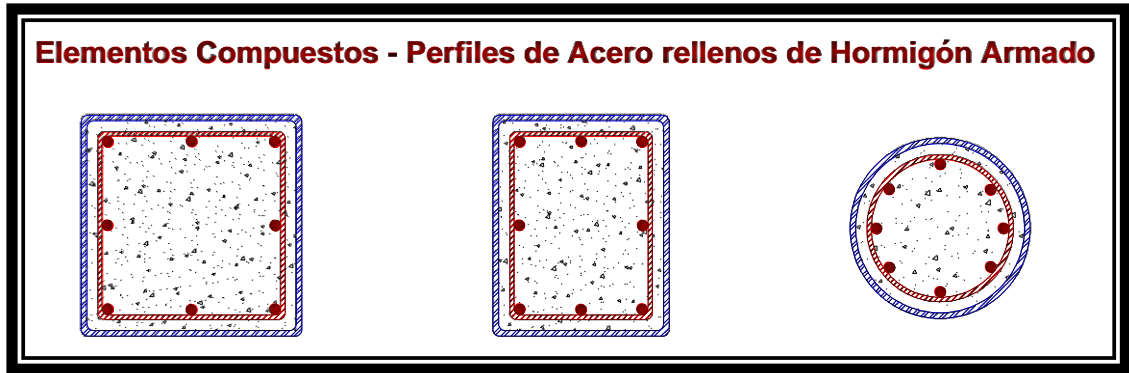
2: Elementos Compuestos de secciones tubulares de acero rellenas de hormigón.
